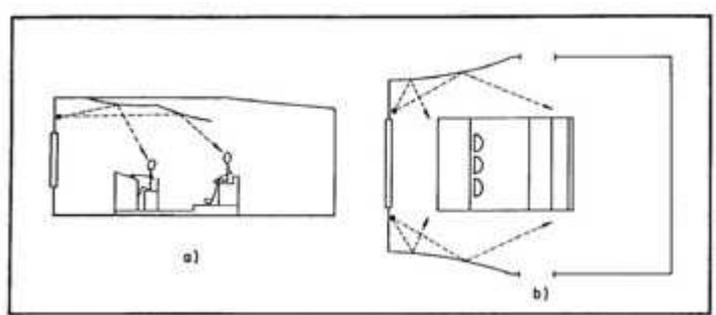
Sala de control Rettinger: a) Alzado b) Planta.
